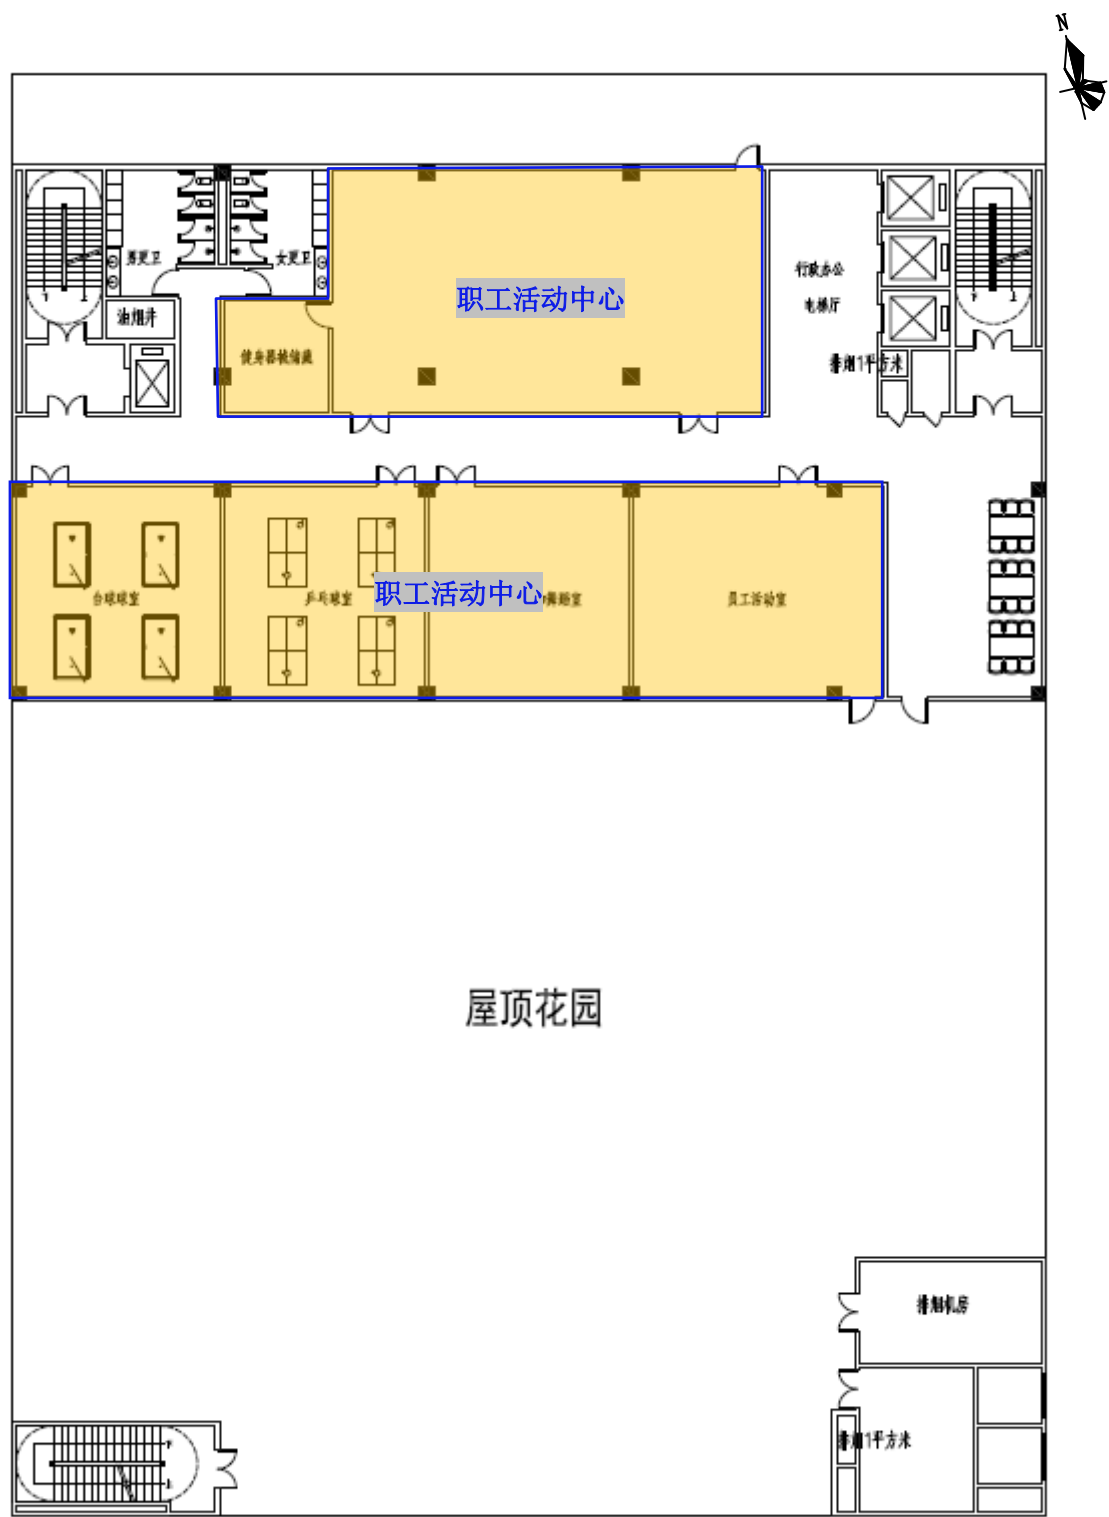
项目医疗综合楼十九层平面布置图（比例尺：1:664）
